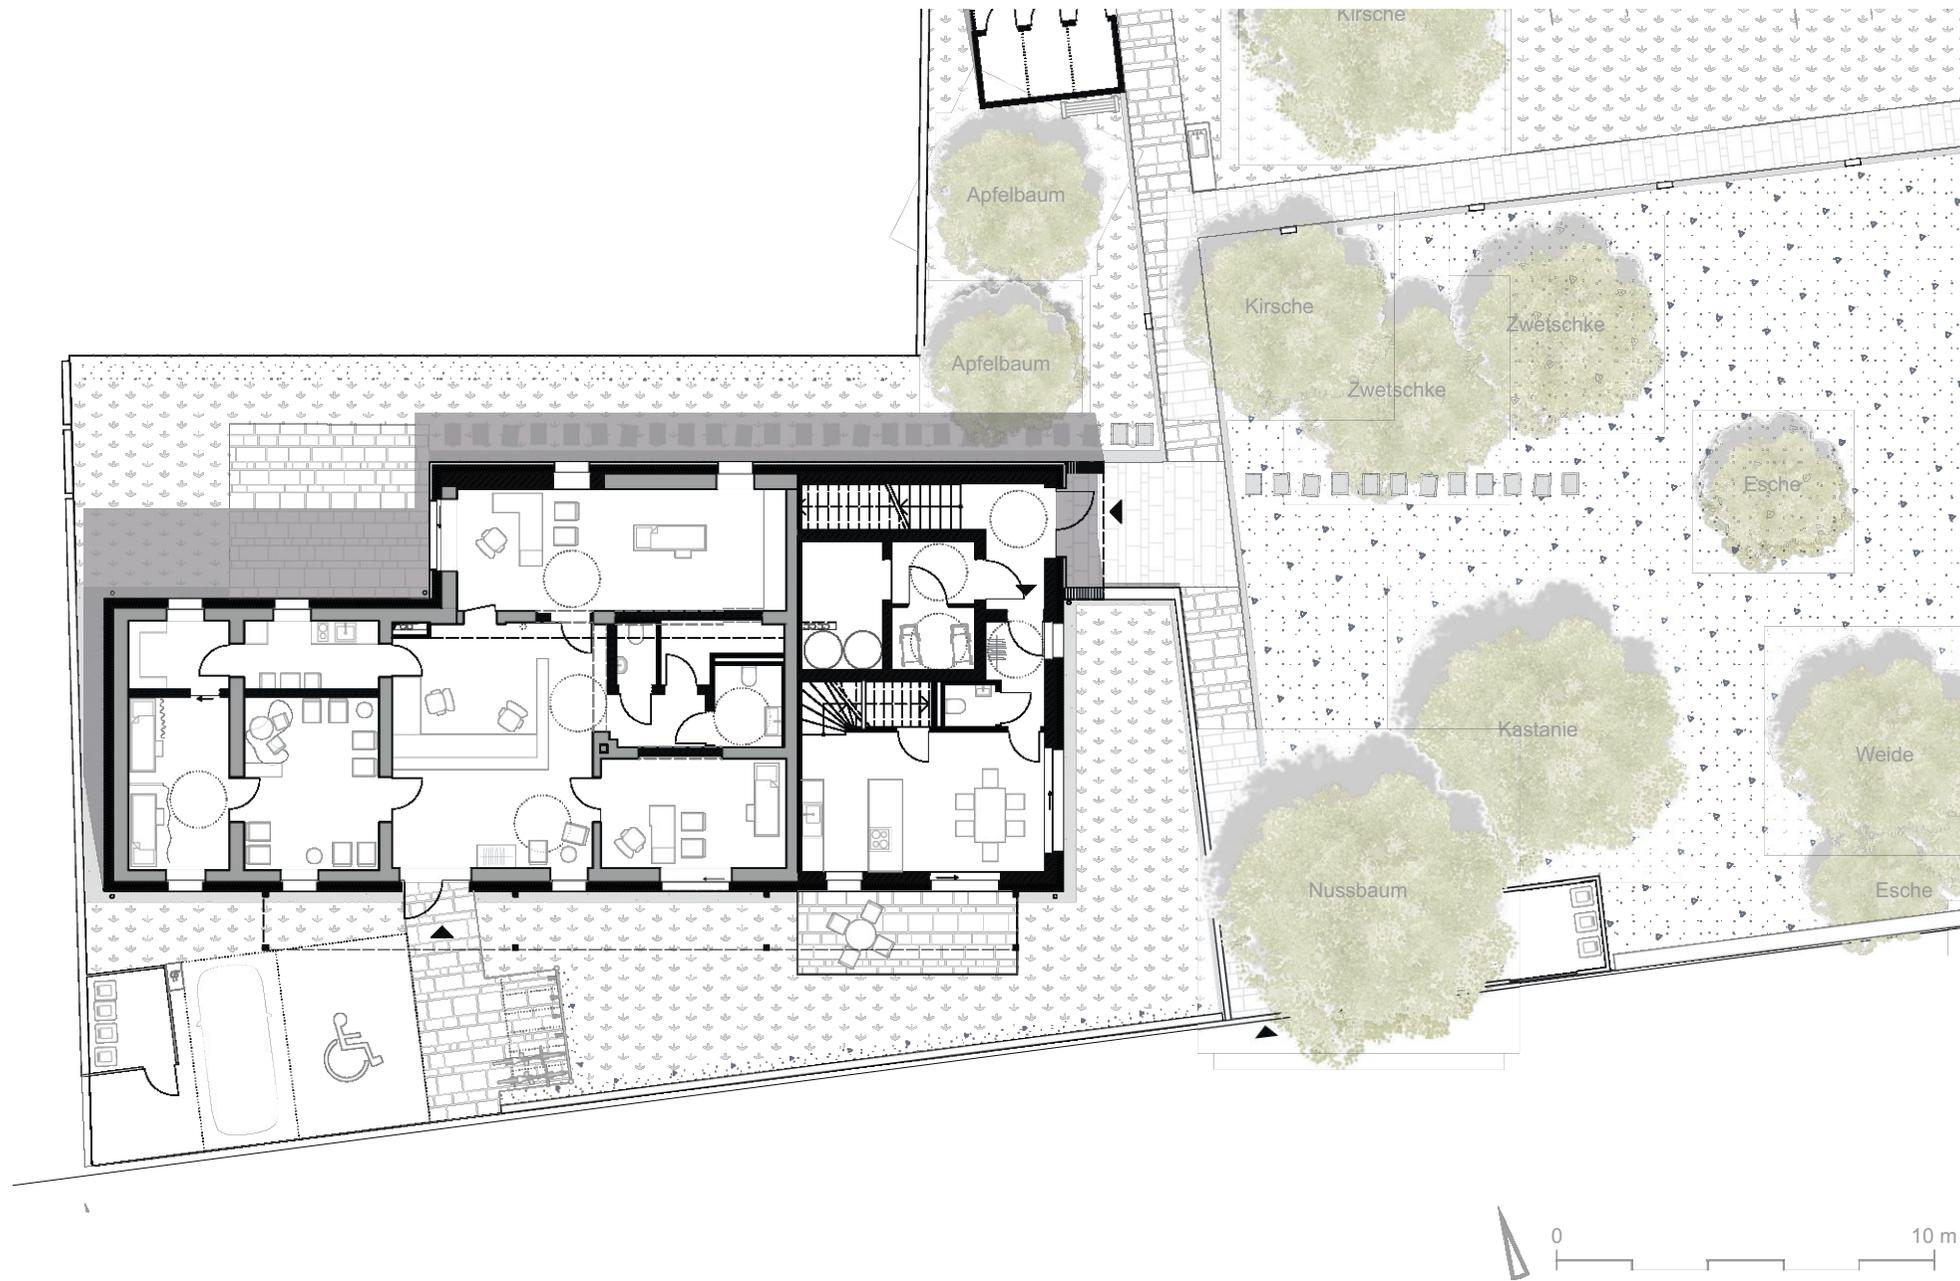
Grundriss Erdgeschoss 1:200 Variante Praxis
